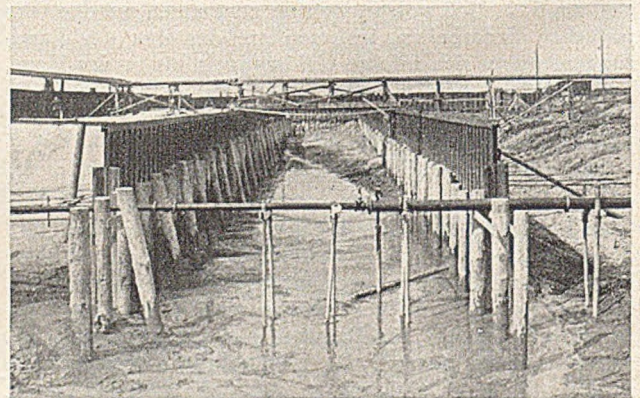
Kammerwände mit Holmen. Baugrube vor dem Aushub. Grundwasserausleitung in oberer Staffel.
